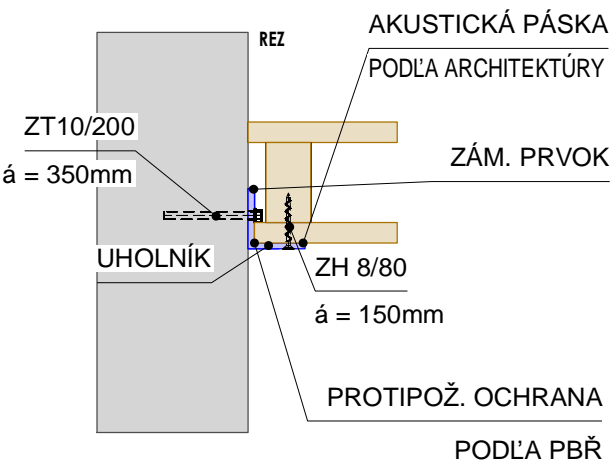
DETAIL "F" - PRIPOJENIE DVOCH STROPNÝCH PANELOV ELEMENT
